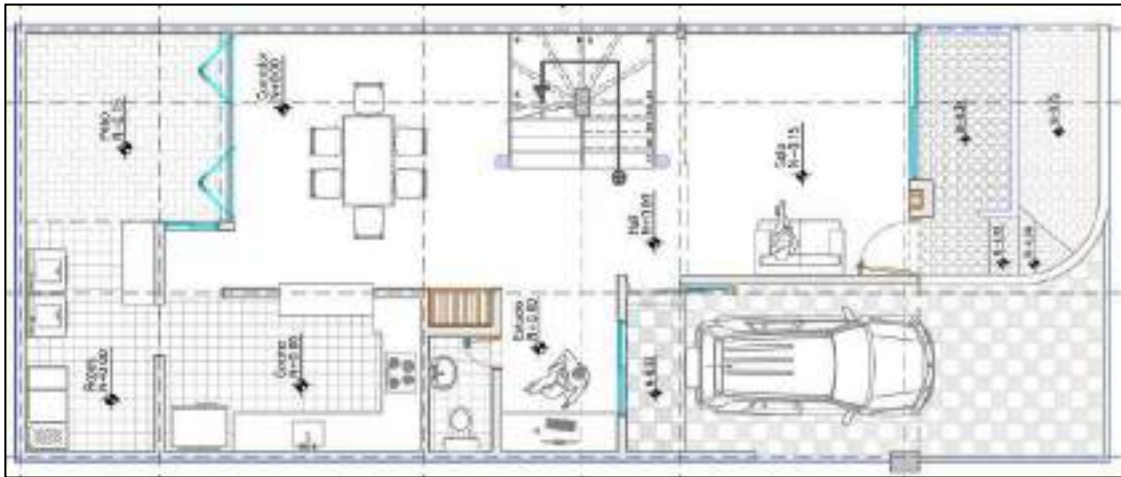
Preliminar Planta arquitectónica Nivel 1
